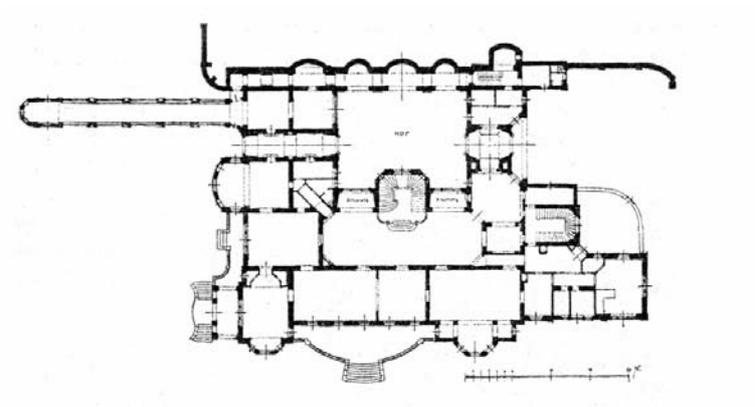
Villa Taussig. Grundriss. 1894.
